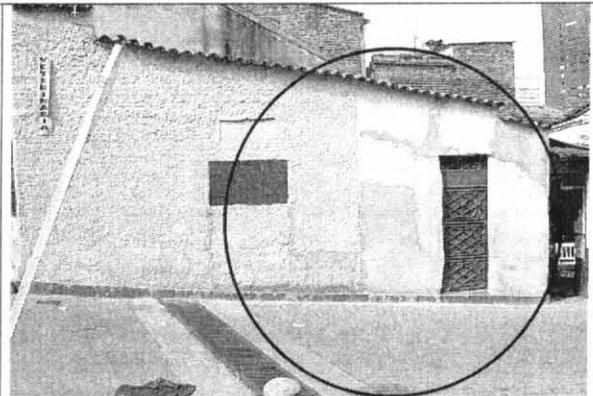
Evidencia de reparaciones superficiales en algunos tramos de muro de la fachada norte.
